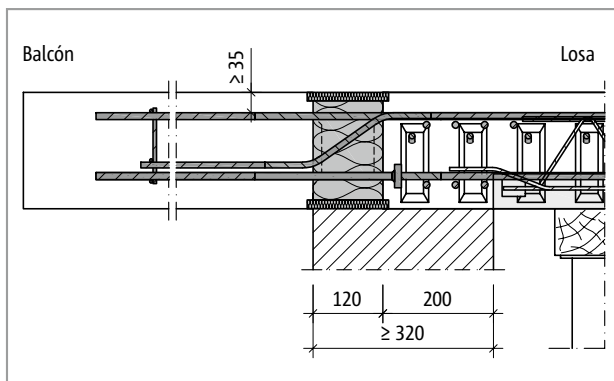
Schöck Isokorb® XT tipo C: Placa prefabricada con apoyo periférico con muro aislante (sección XT tipo C-L-CV35, vista XT tipo C-R-CV50)
